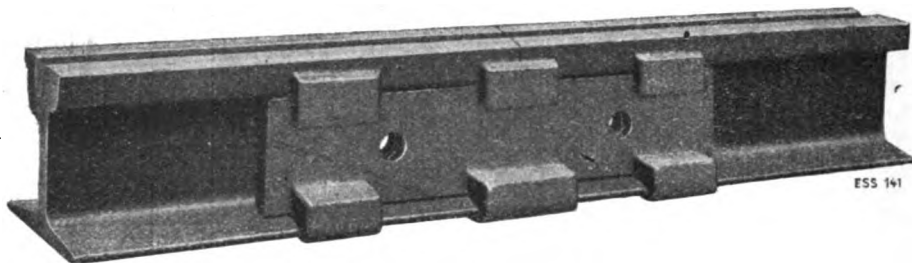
Schweißstoß mit Flachlaschen.
